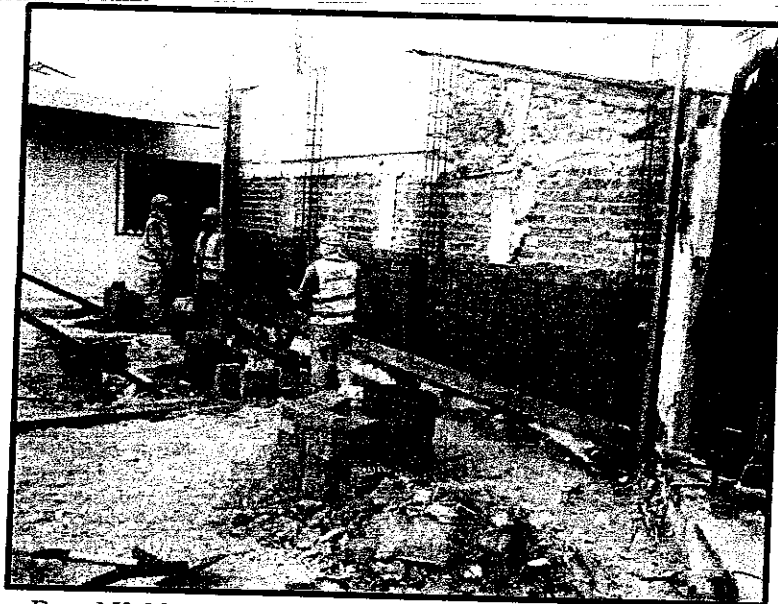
Actividad de Tabiquería en el muro lateral.
